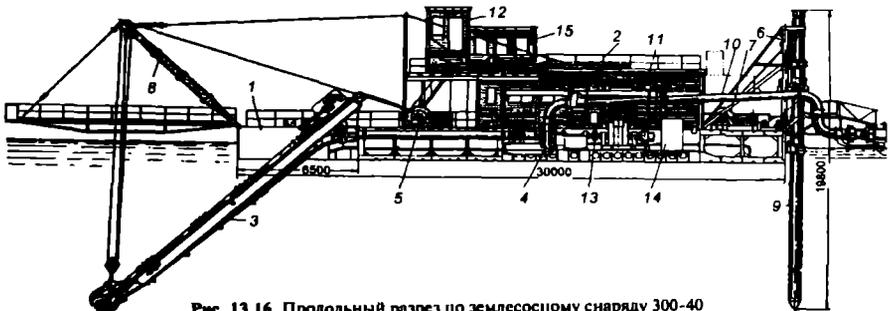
Продольный разрез по землессноному снаряду 300-40
